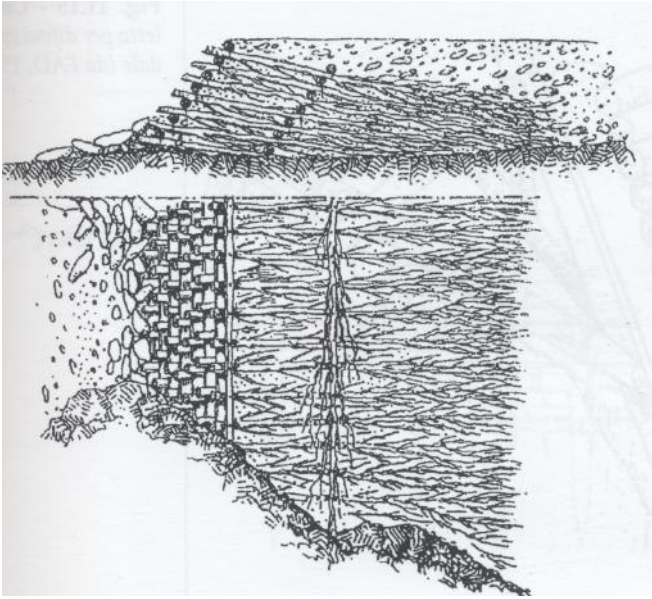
Sezione e planimetria della briglia Duile (1826) costruita in terra rinforzata con alberi interi
